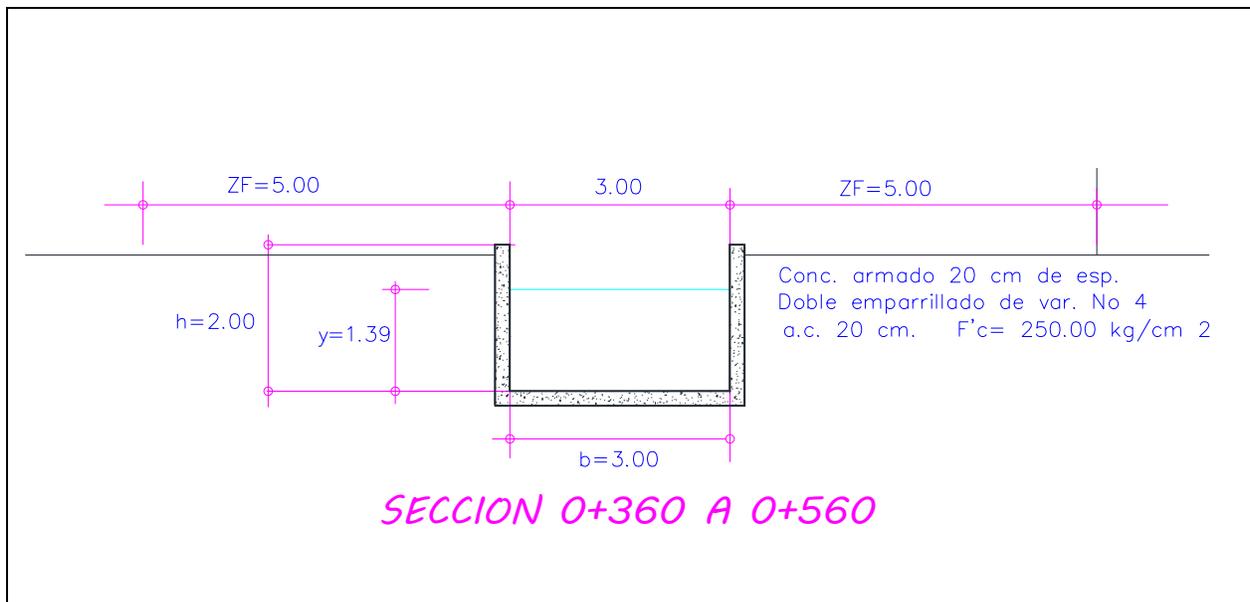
Diagrama que muestra corte de la sección tipo del canal de concreto.
